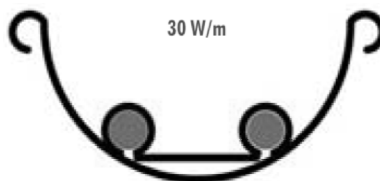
Coupe transversale d'une gouttière mi-ronde avec câble chauffant et entretoise
